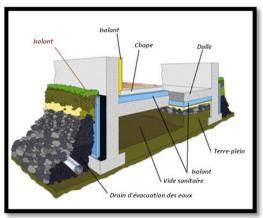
ITE murs et plancher sur vide sanitaire. Disponible sur :http://ale-montpellier.org/particuliers/construire-et-renover-ma-maison/isolation/lisolation-des-planchers/ (consulté 26/12/2016).
